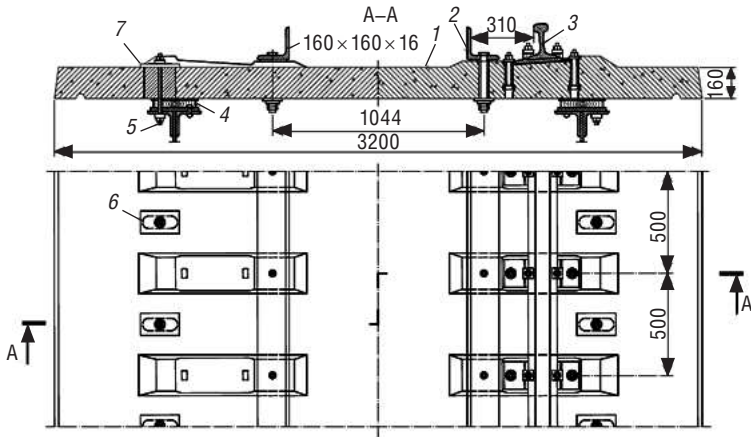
Мостовое полотно на железобетонных плитах без балластного мостового полотна:
